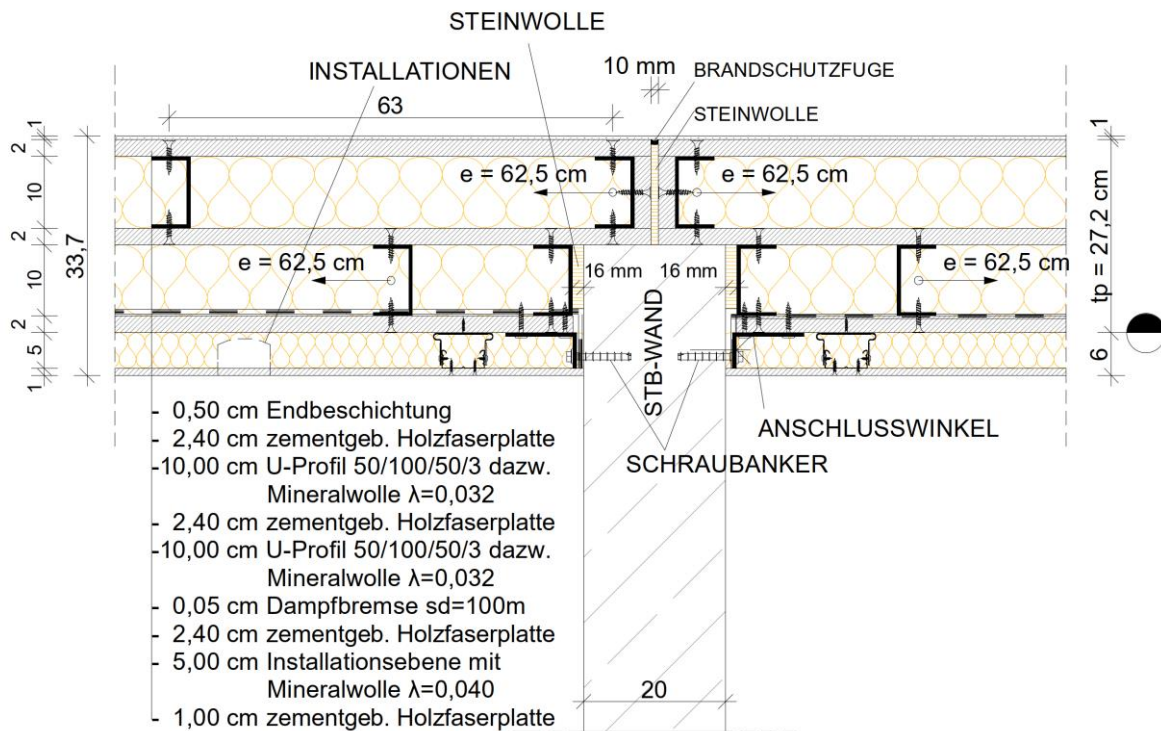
Grundriss Anschluss Stahlbetonwand
